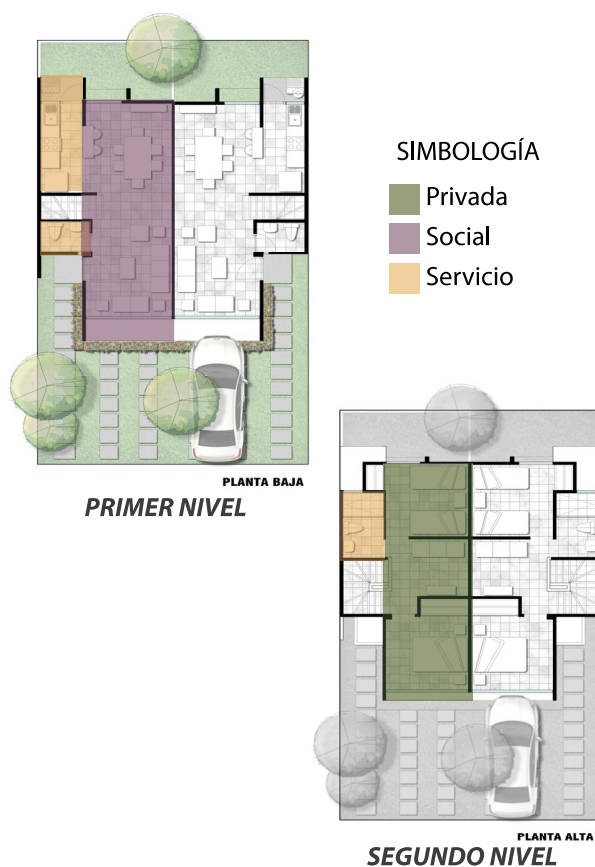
| Zonificación y planta arquitectónica de un modelo de vivienda. Fuente: Elaboración propia.
